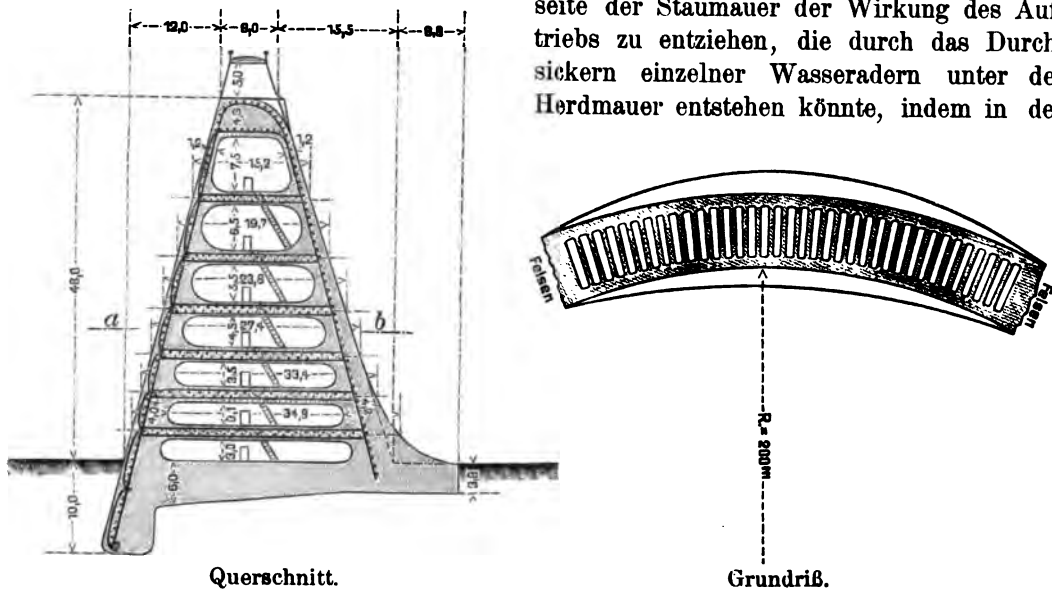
Eisenbetontalsperre nach Ziegler und Schacht.
